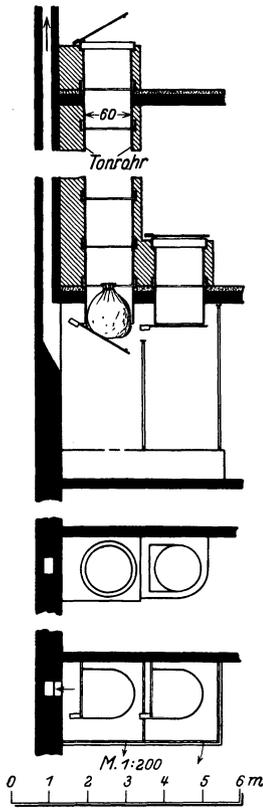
Wäscheabwurf-schacht. Schnitt- u. Grundrisse des Erd- und Keller-geschosses.
